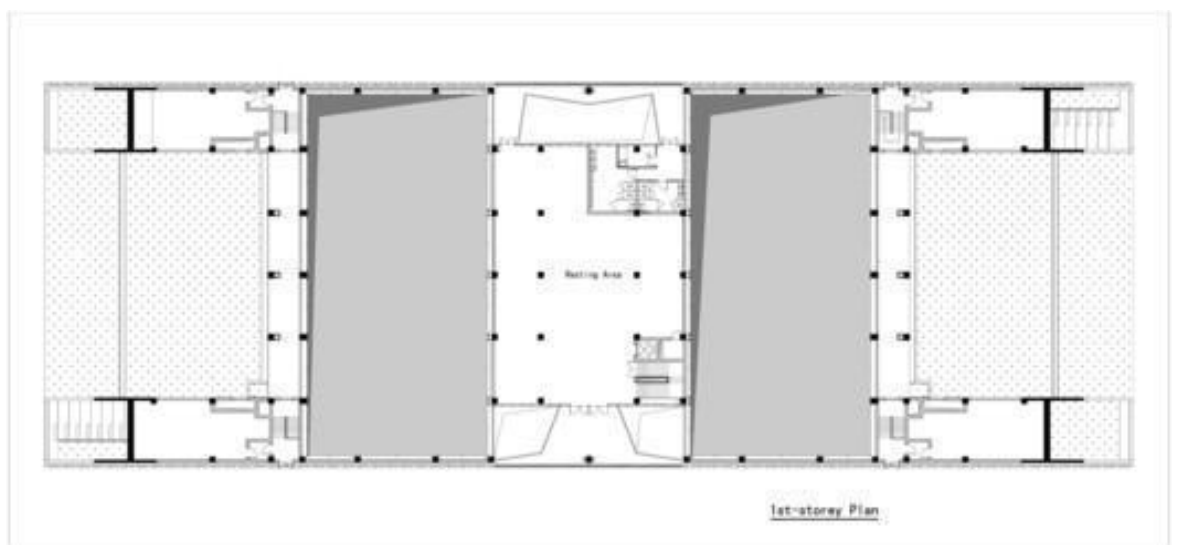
План другого поверху клубу Йонцзян [7]
